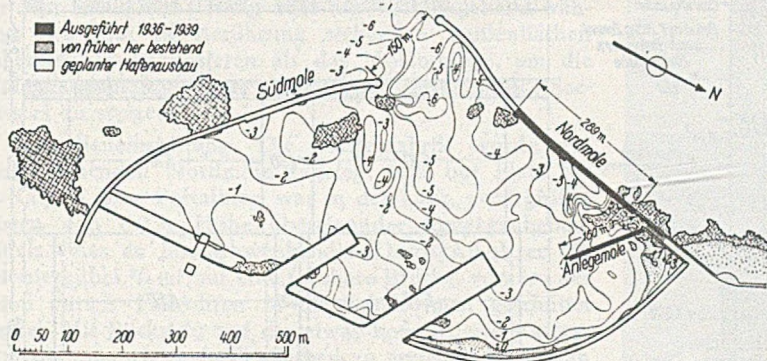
Geplante und ausgeführte Hafenanlagen.
